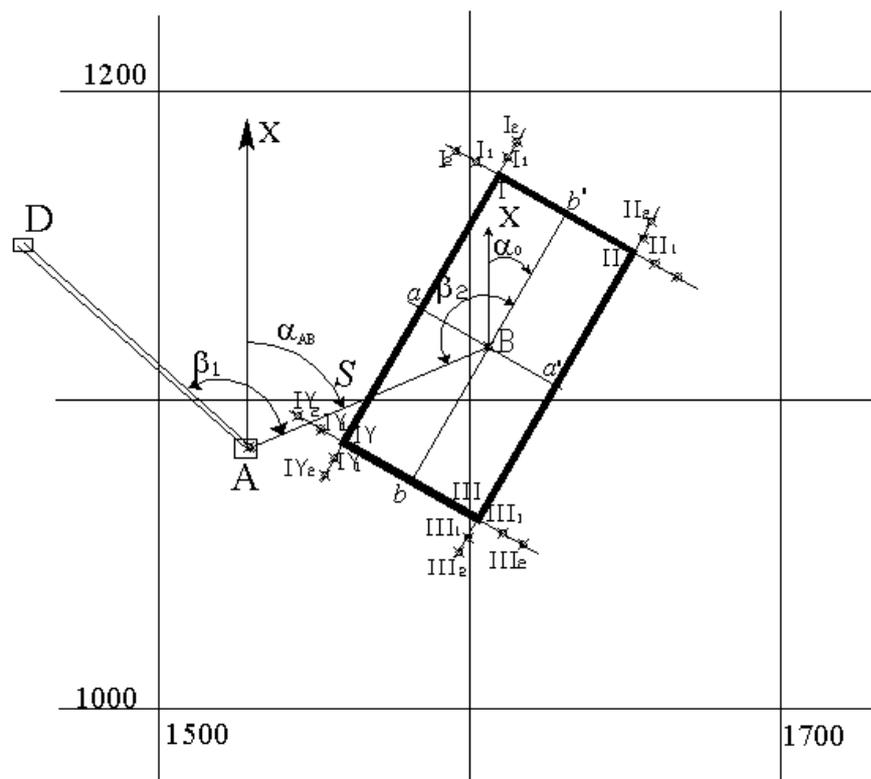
Пояснительная схема к проекту разбивки здания на промышленной площадке карьера.
